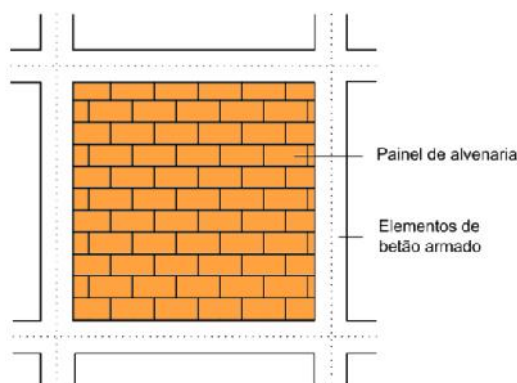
Comportamento monolítico entre os elementos estruturais de betão armado e parede de alvenaria de enchimento.
